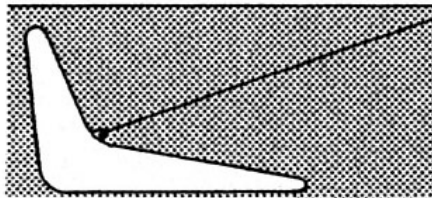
Eingegrabener Betonwinkel [Otto 1958]
